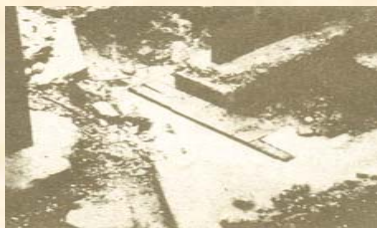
美国某净水厂工厂墙体开裂与倾斜； 图5-6-24美国某净水厂沉淀池破坏情况
